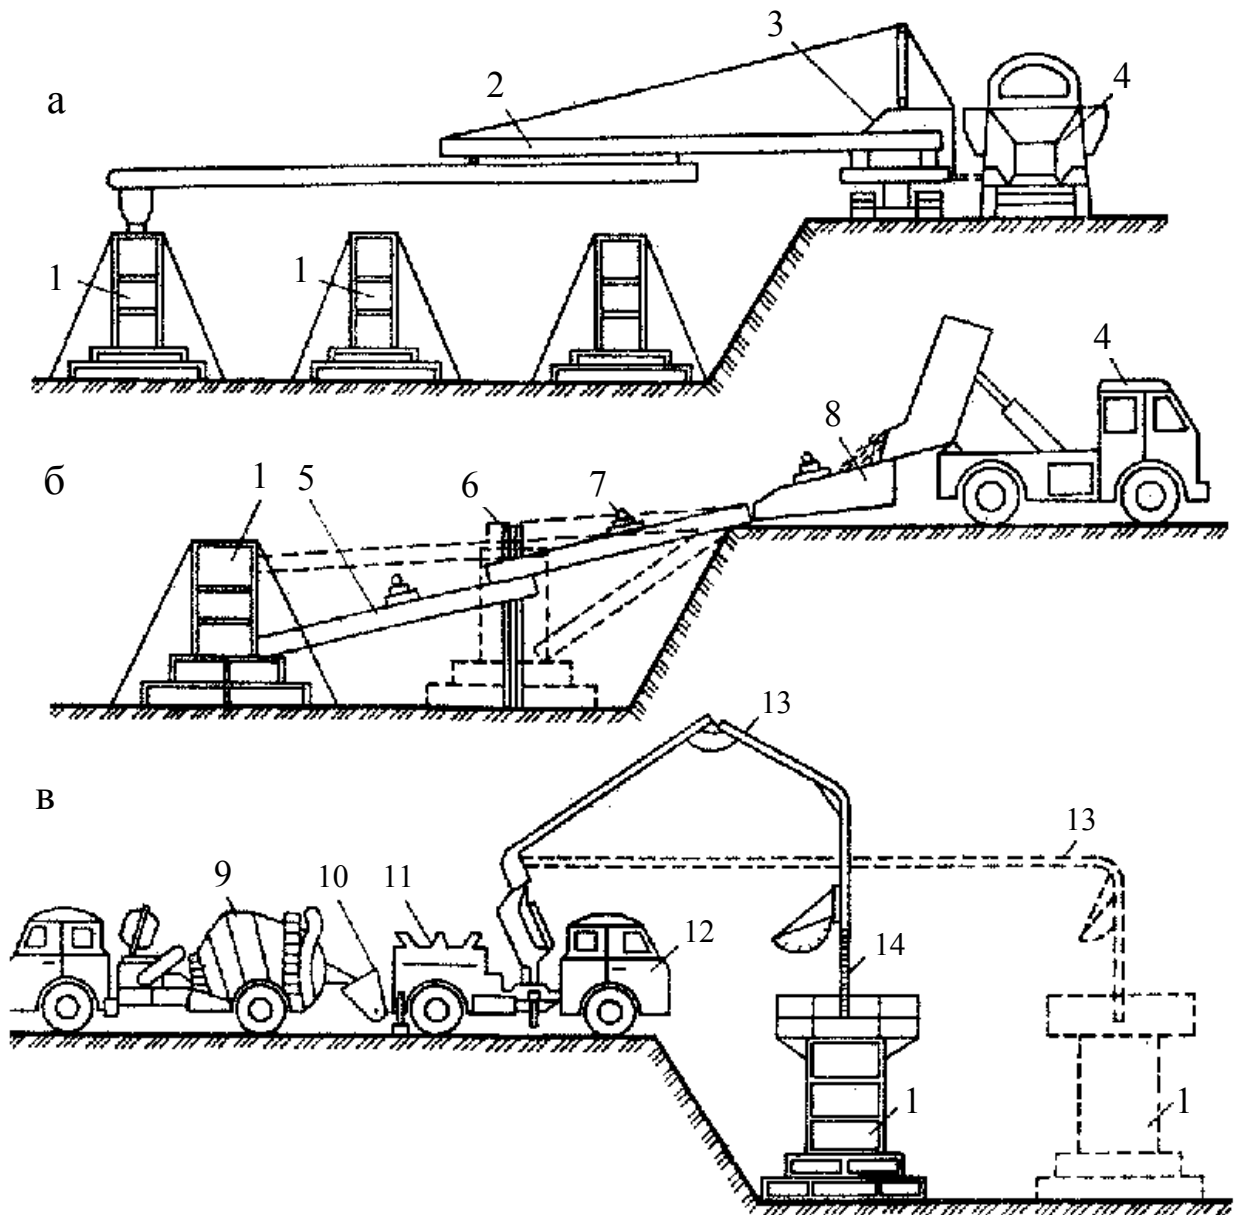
Технологічні схеми бетонування фундаментів:
